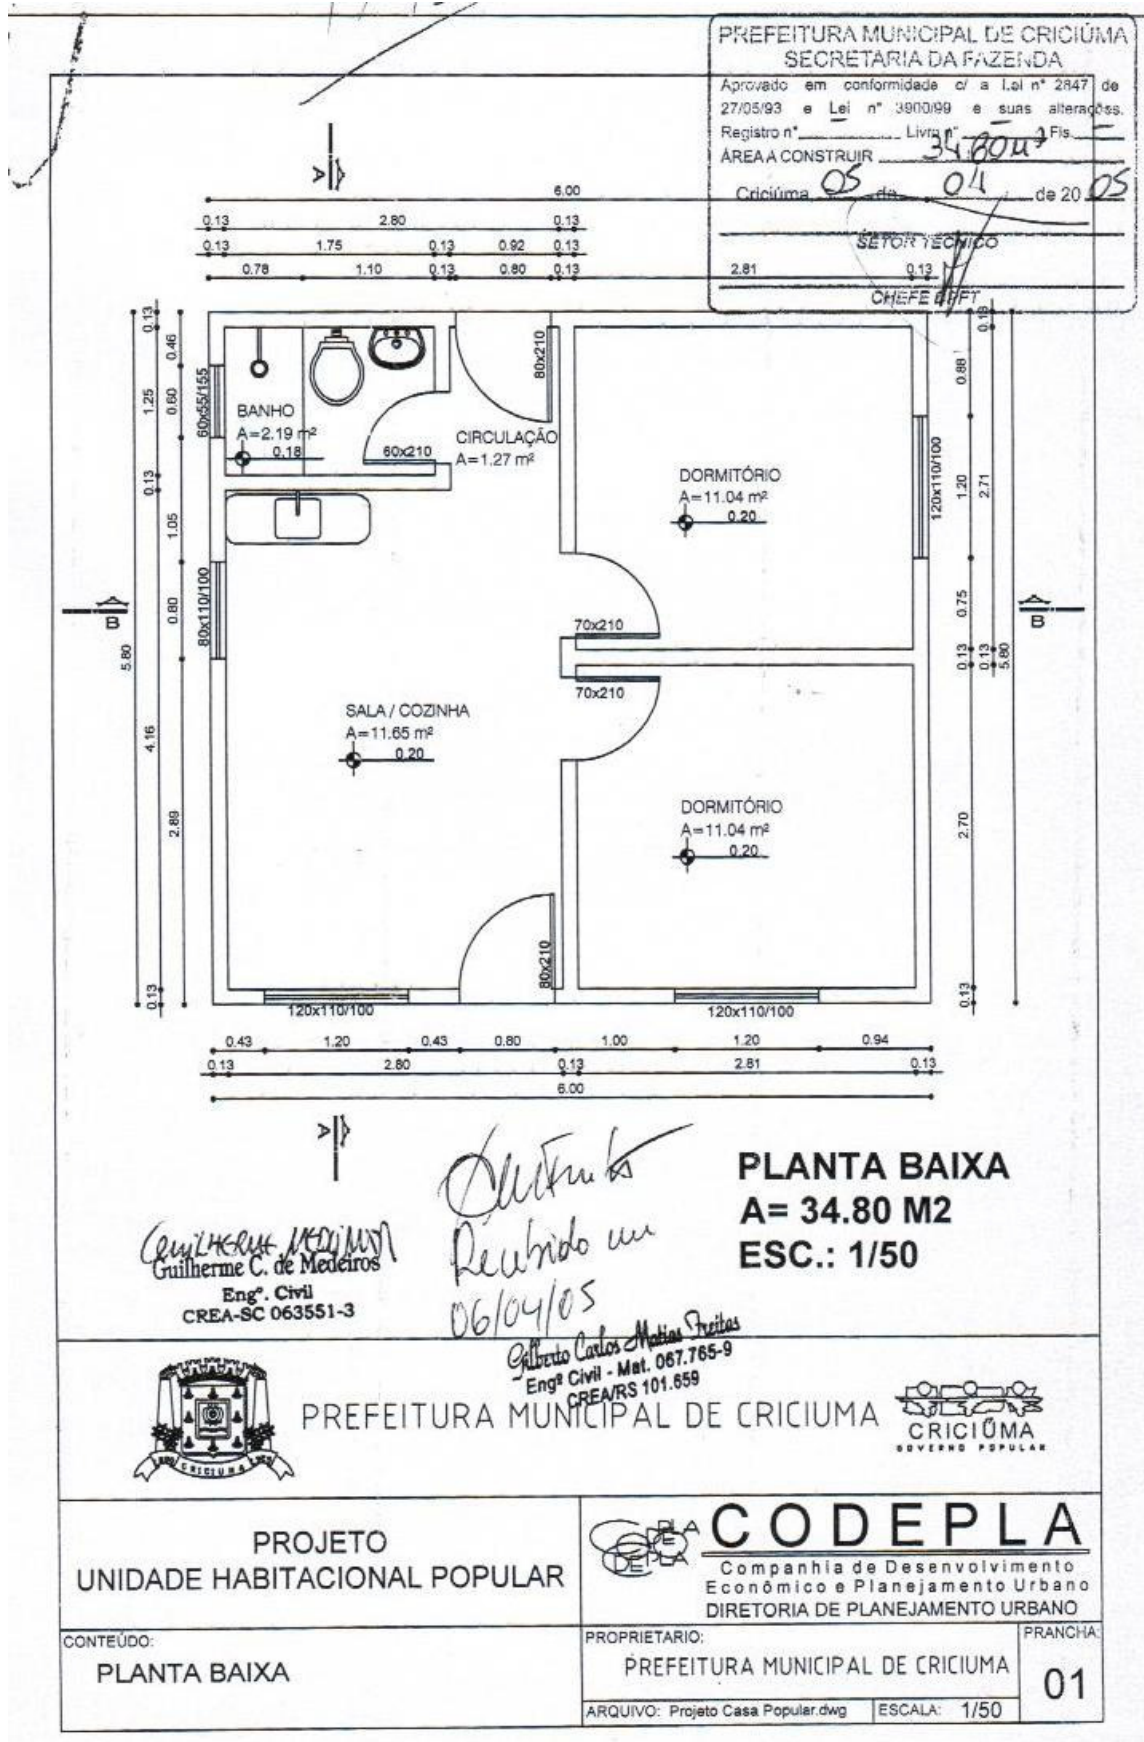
Planta baixa das 31 unidades habitacionais construídas para desabrigados em Criciúma – SC, em decorrência do furacão Catarina.
